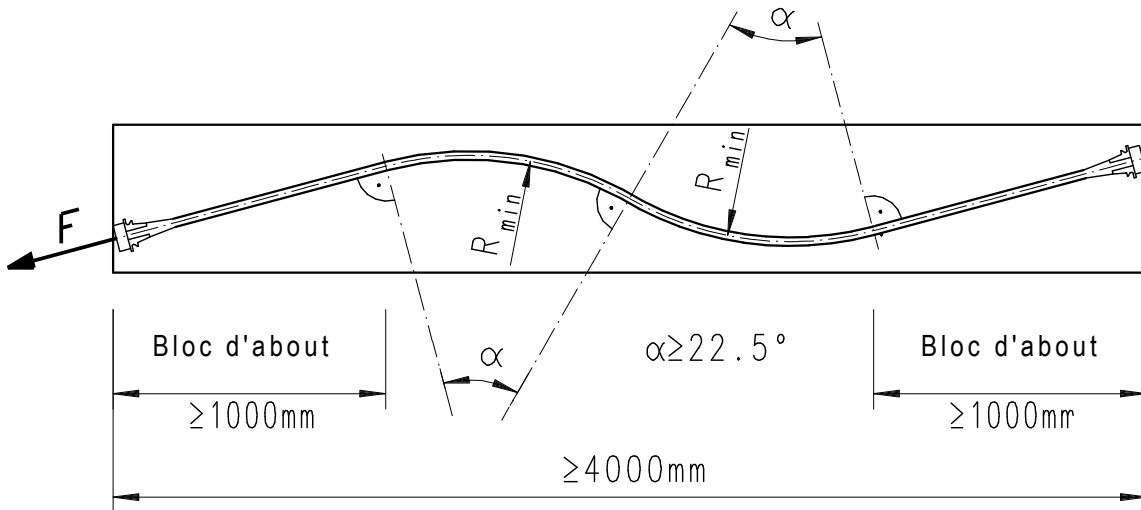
Installation pour l'essai de remplacement d'un câble intérieur
